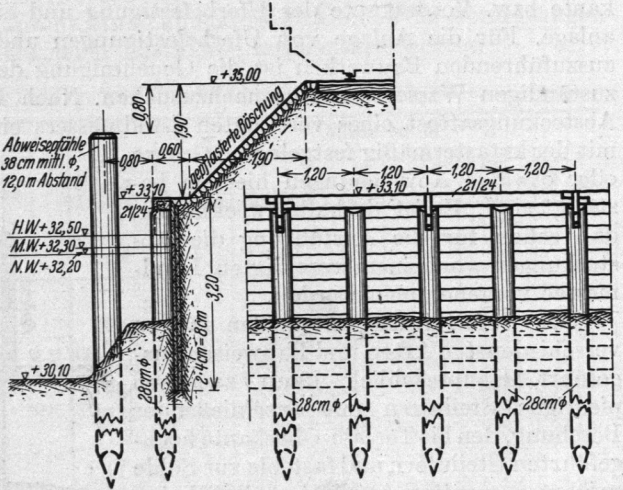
Uferbefestigung aus hölzernen Rammfählen mit dahinter liegender Holzbohlwand.
